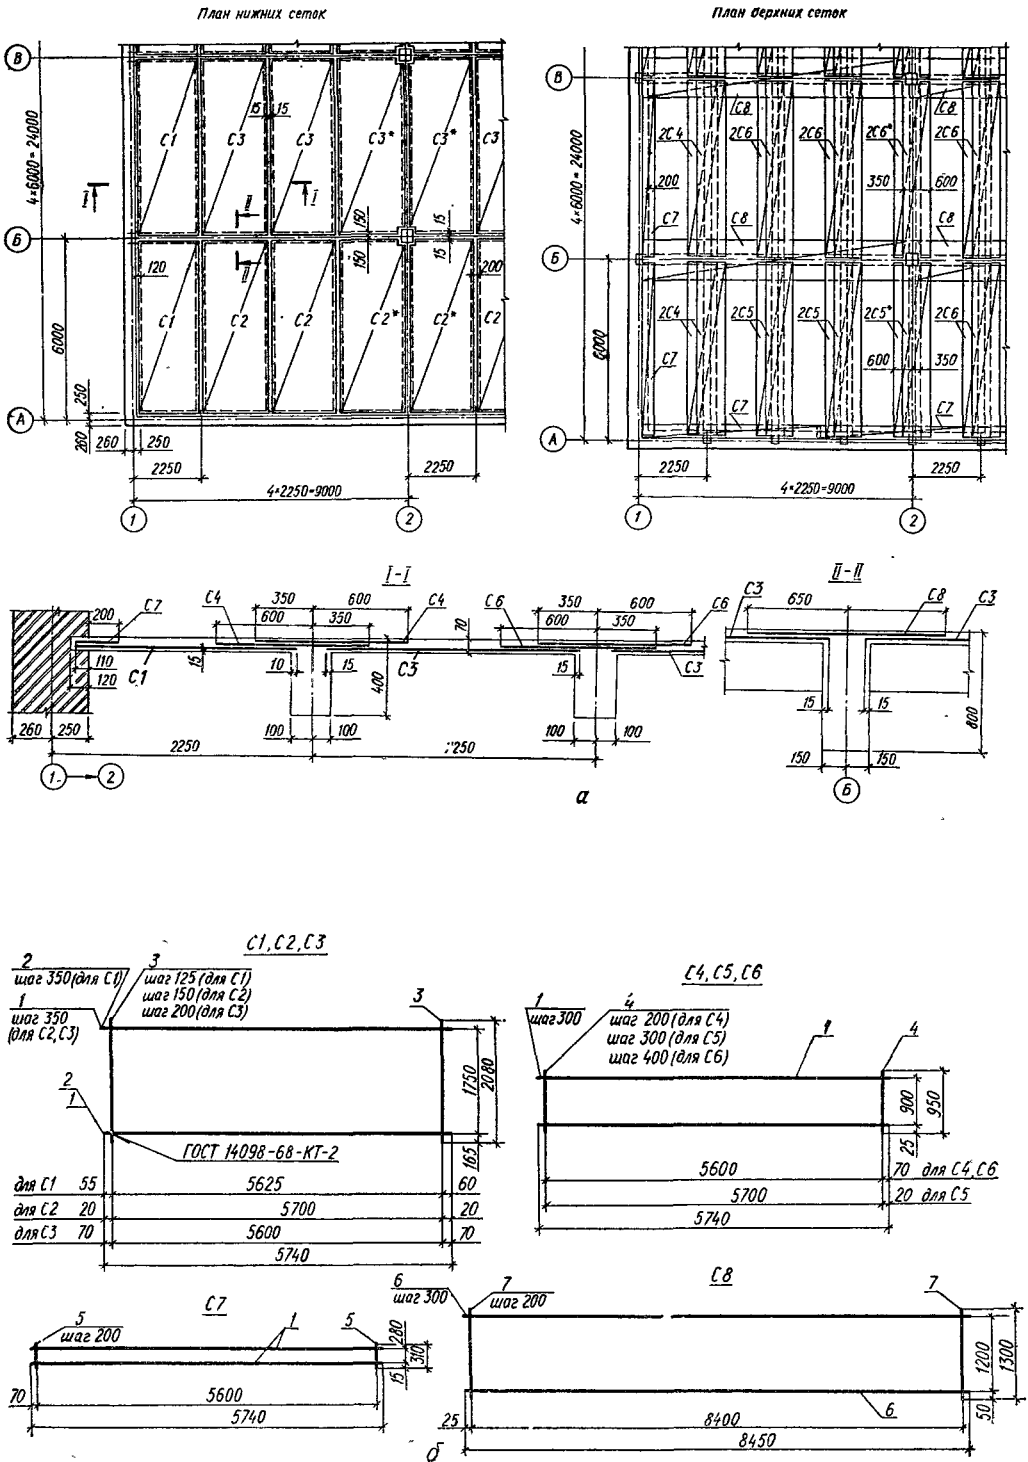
Армирование плиты ребристого перекрытия сварными рулонными сетками с поперечным направлением рабочих стержней:
